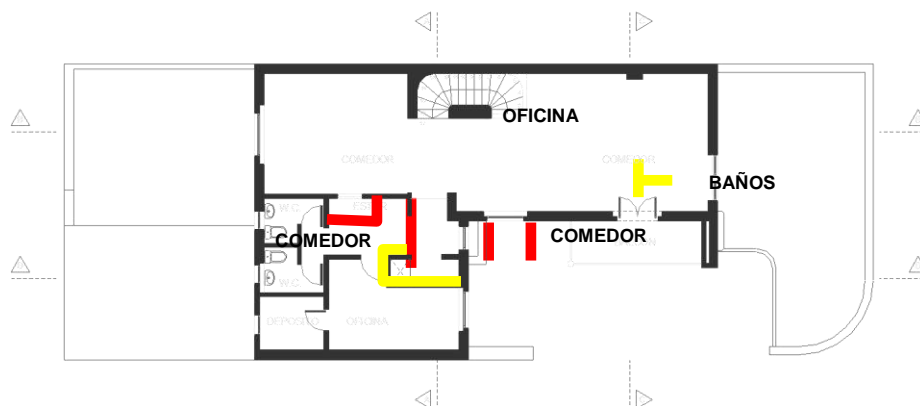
Plano de levantamiento 2015 planta piso 1
